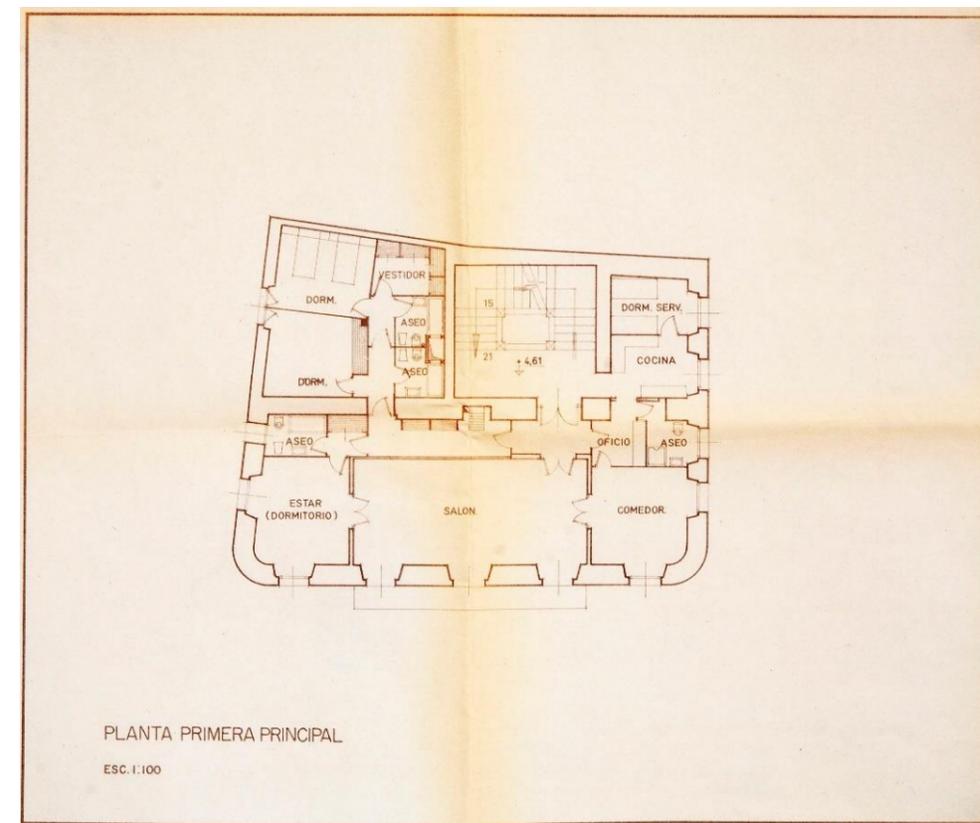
Planta primera del proyecto de reforma de la Casa Cornide para residencia de Carmen Polo. Ca. 1962-1963. AMC. Planos Extraídos-Alcaldía-Correspondencia C-6529 (11). nº 1156. Foto José Caruncho.
